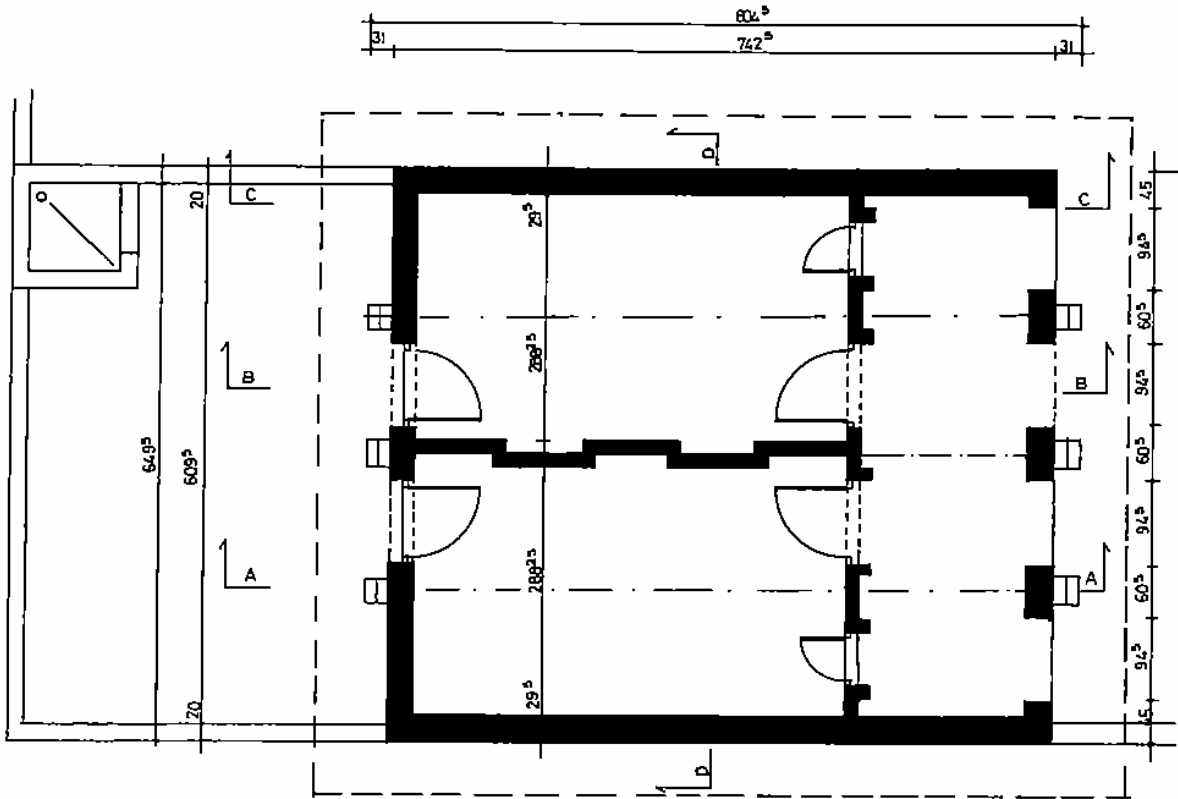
Logement de fonction : plan de la maçonnerie des murs en 29,5 cm et 14 cm d'épaisseur.
